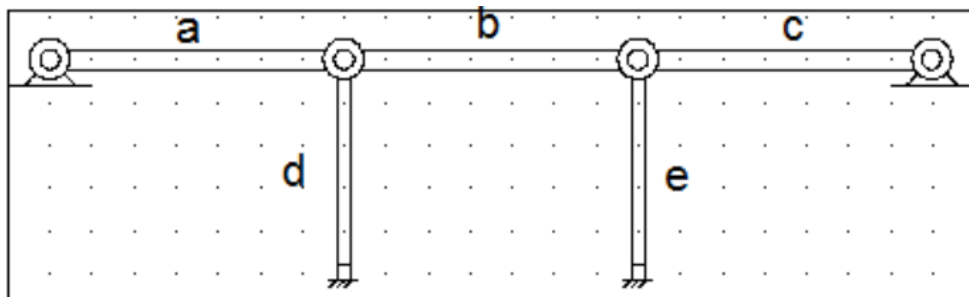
"pórtico viga-pilares." fuente propia CESPLA
